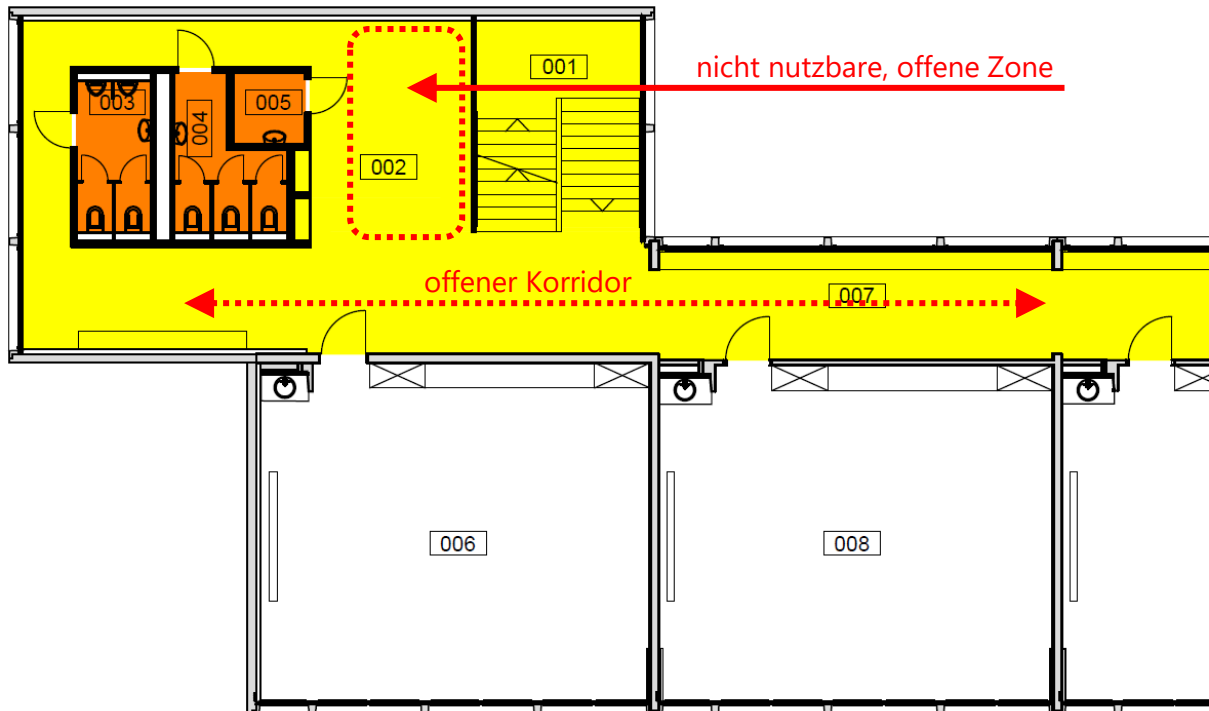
Grundrissausschnitt OG Klassentrakt 1 - IST
